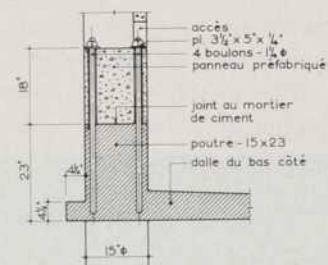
COUPE A-A - POUTRE DE LA NEF
